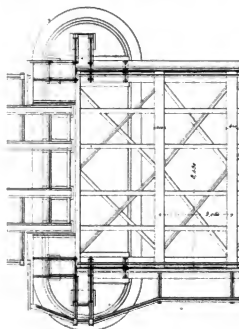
Elevation sur une pile, côté de la passerelle (Amont)
